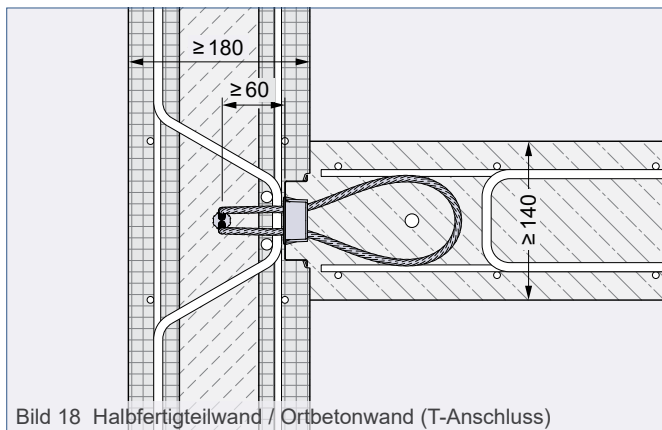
Halbfertigteilwand / Ortbetonwand (T-Anschluss)
